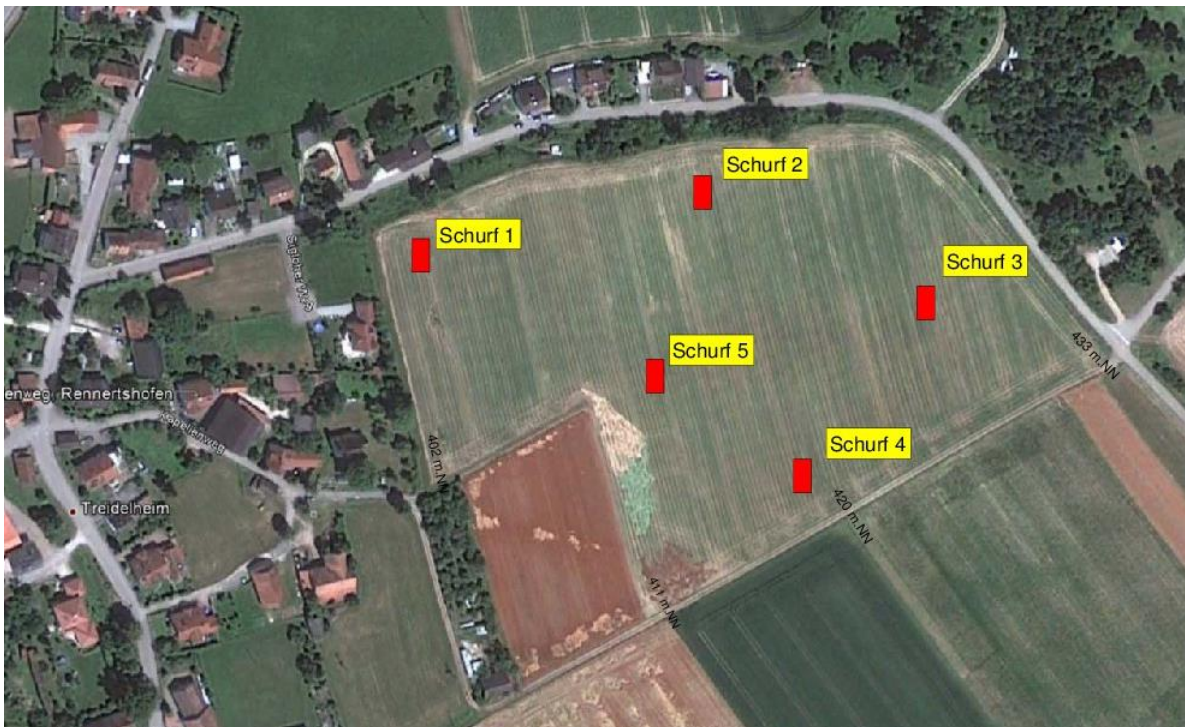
Lageplan mit Aufschlusspunkten (Quelle: KPI 2012)
